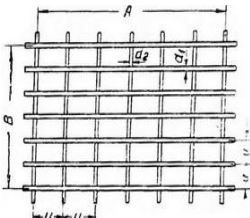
Арматурный каркас, изготовленный методом вязки перекрестных стержней с помощью вязальной проволоки
